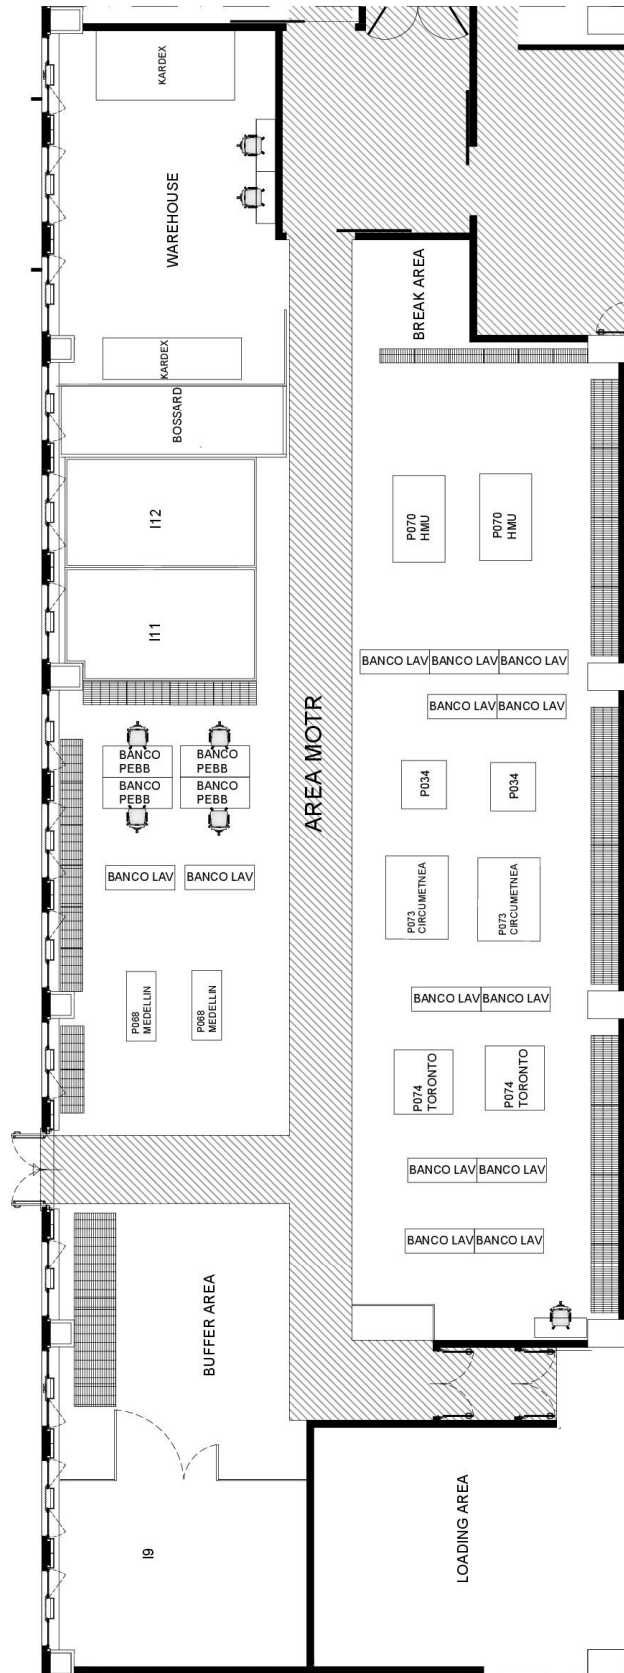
Attuale planimetria dell'area occupata al piano terra dalla divisione MOTR nello stabilimento
